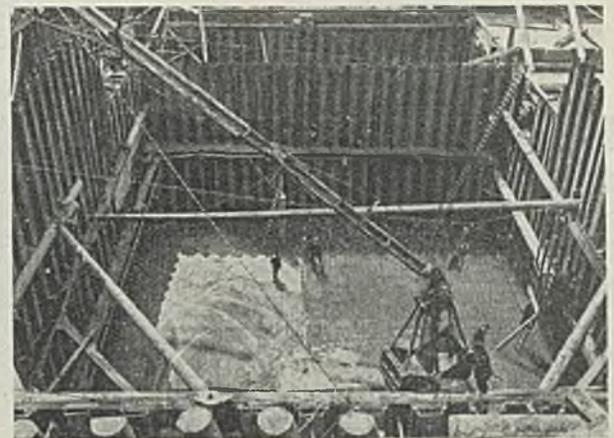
Betonierung der Sohlplatte des südlichen Torpfeilers am Außenhaupt.
